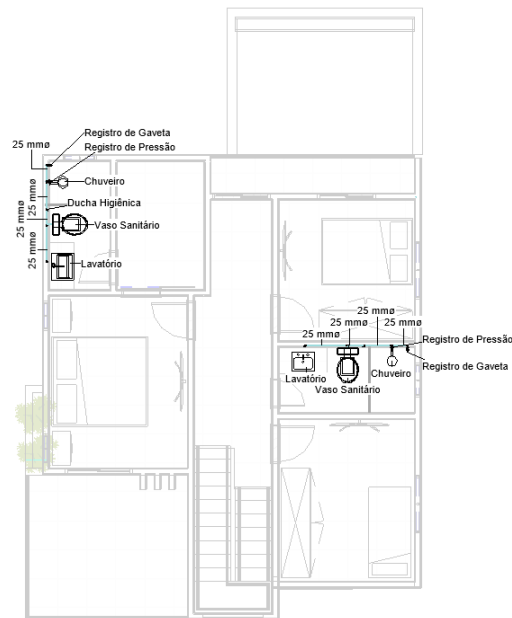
Planta Baixa da Instalações de Água Fria – Pavimento Superior
